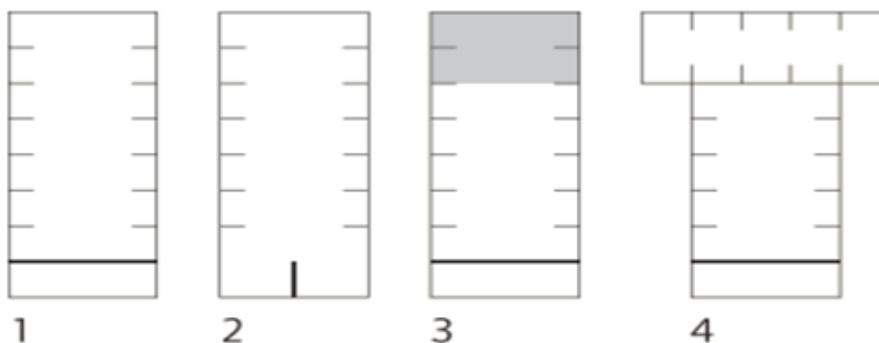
Схемы композитных балок: 1 - армирующая пластина по горизонтали между предпоследней и последней деревянными ламелями; 2 - вертикальная армирующая пластина; 3 - армирующая пластина в растянутой зоне сечения. В сжатой зоне размещаются слои древесины с повышенной прочностью; 4 - поперечное сечение тавровой балки с усилением растянутой зоны.
